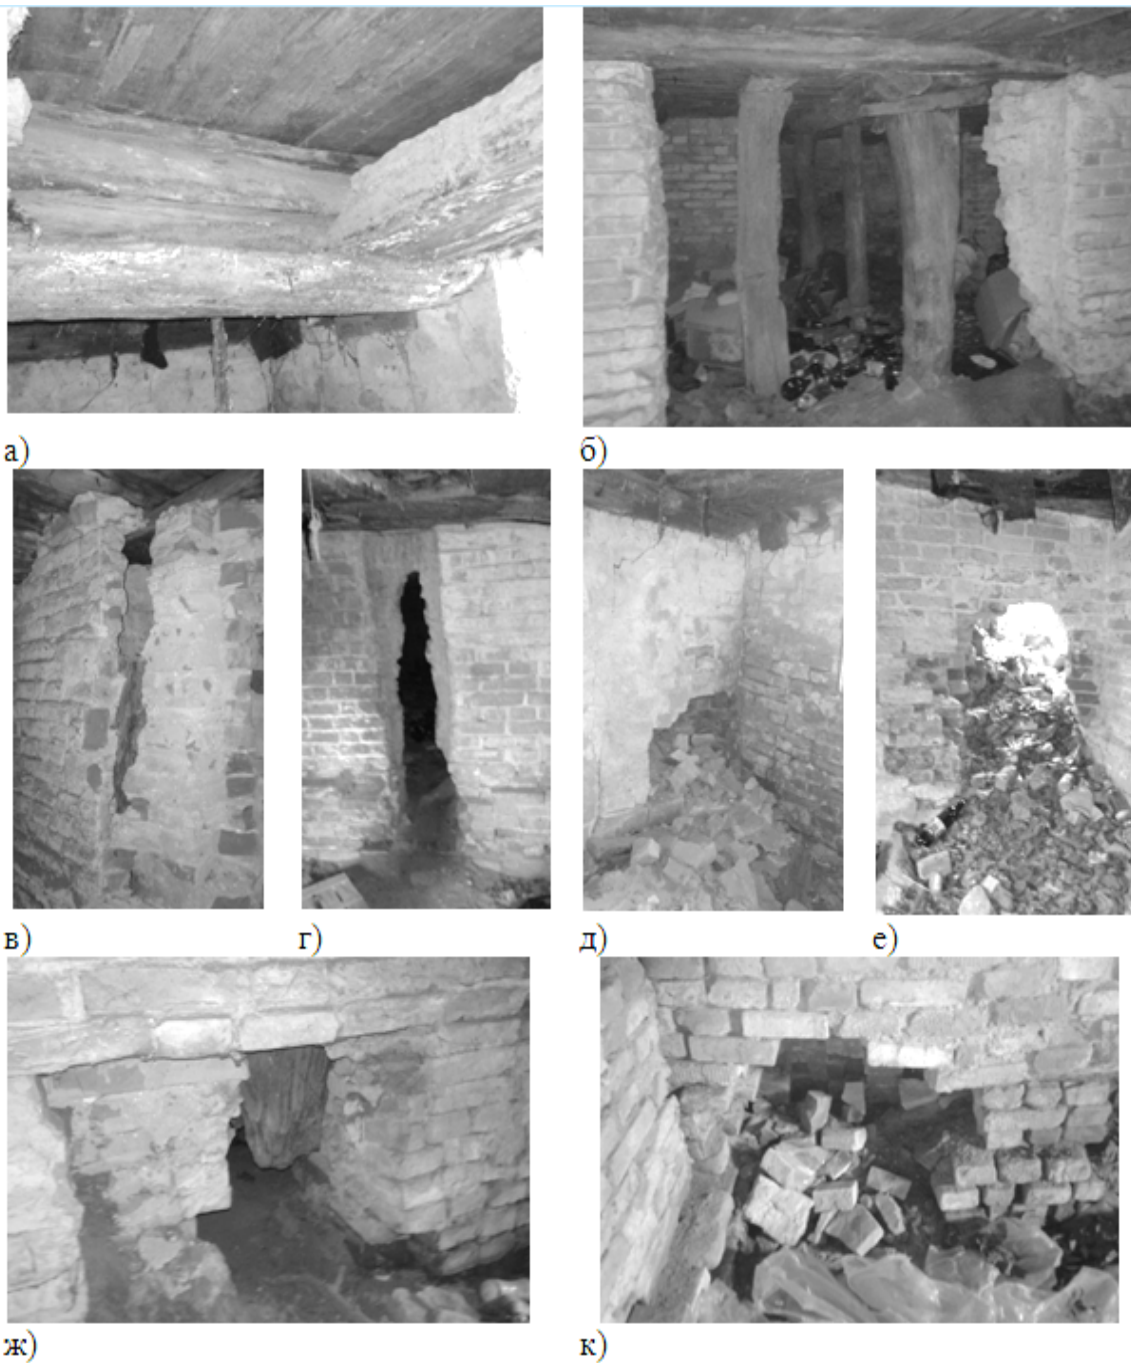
Деформації підвальної частини: а) – обрушення дошок коробового перекриття; б) – дерев'яні колоди, які підтримують балки перекриття; в) – внаслідок гниття нижнього кінця дерев'яного стовпа, який замуrowаний в стіну, він сповз на 10-30 см донизу, що спричинило розрив цегляної кладки; г) – певні дерев'яні стовпи перетворилися на попіл, а в місцях де вони були замуrowані в цегляну стіну утворилися порожнини; д) – руйнування кута будинку; е) – утворення отворів в цегляній стіні, та сповзання ґрунту в приміщення; ж) – нижній кінець стовпа, що висить в повітрі, тіло колоди замуrowане в кладку; к) – випадіння цеглин зі стіни
